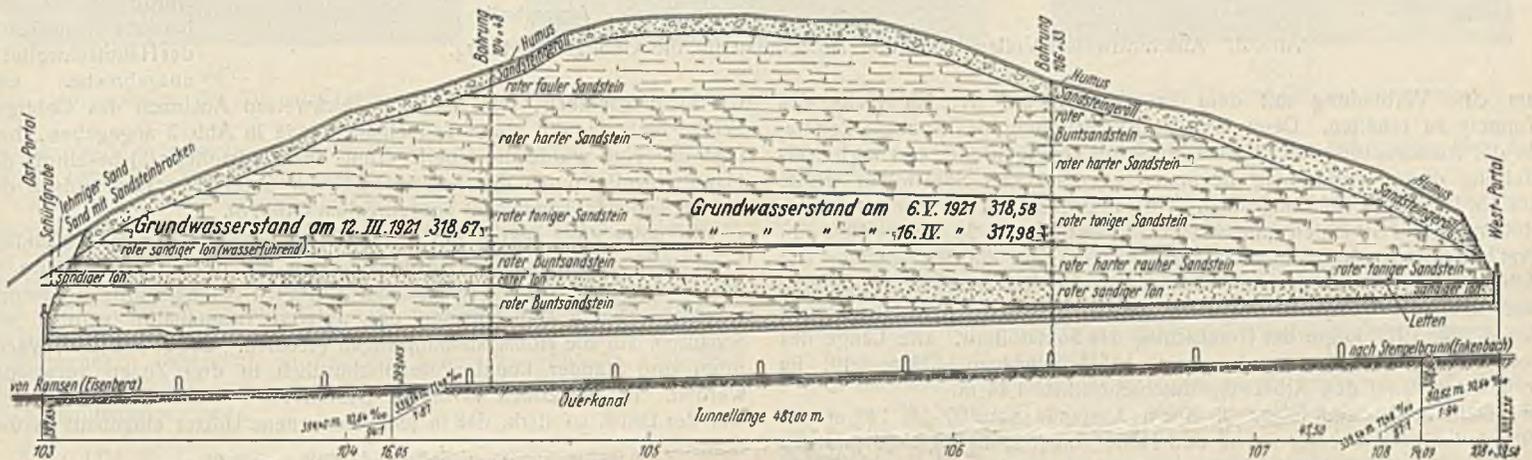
Längsschnitt mit den Bohrungsergebnissen.
